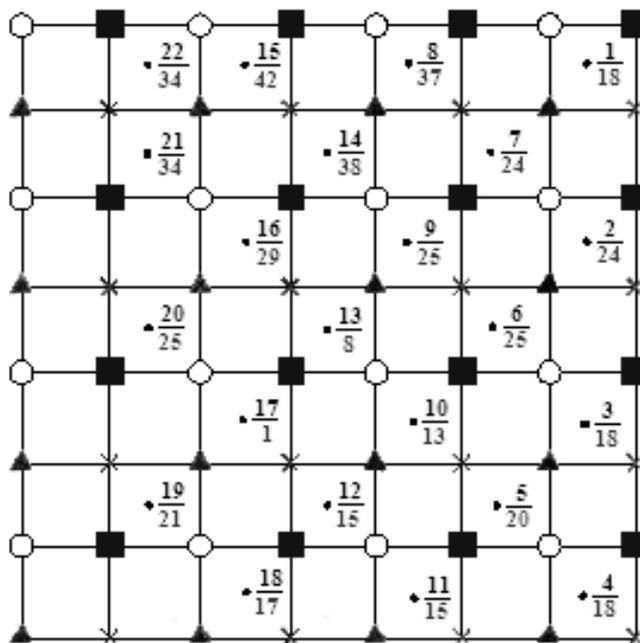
План опытного участка уплотнения грунта основания последовательным взрыванием зарядов.
